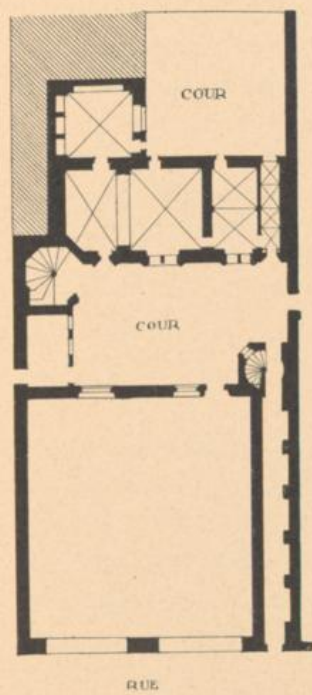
DIJON: HOTEL CHAMBELLAN. — Plan du rez-de-chaussée
